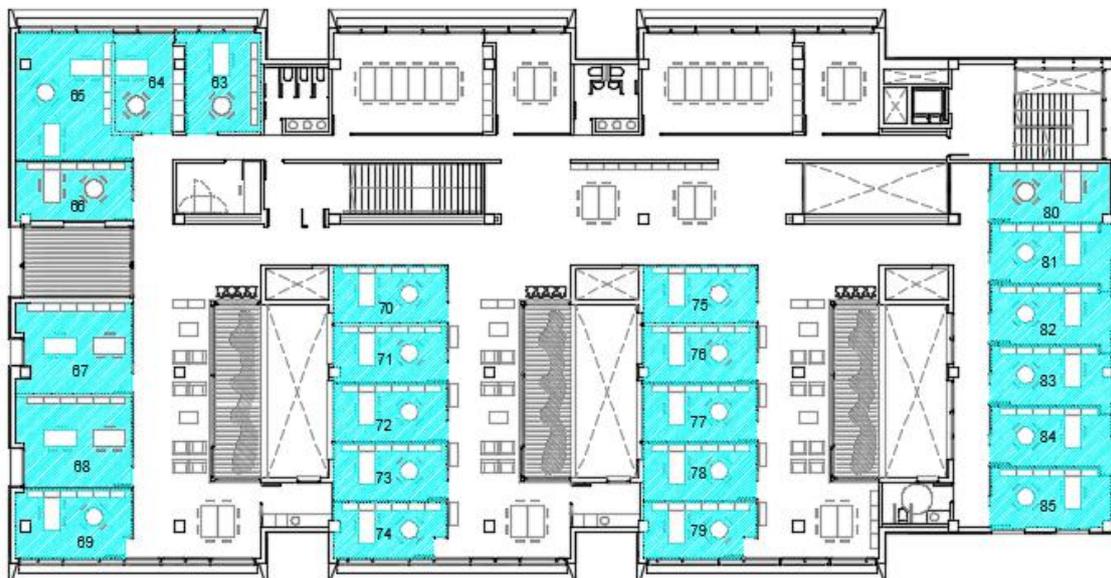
Situación Despachos en Planta Tercera. Figura extraída del plano 55.
